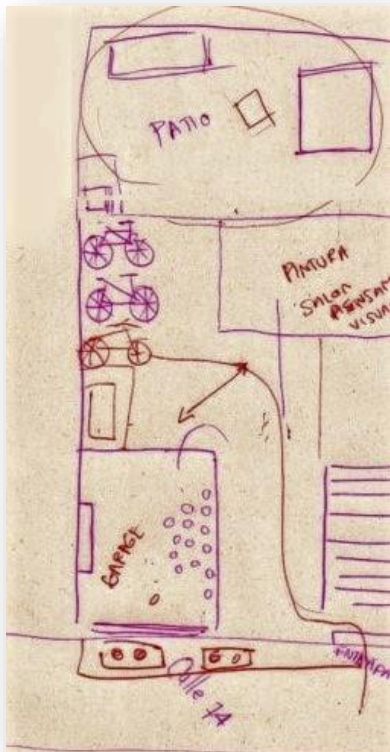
, plano primera planta instalación de la 74, estudiante SJ
